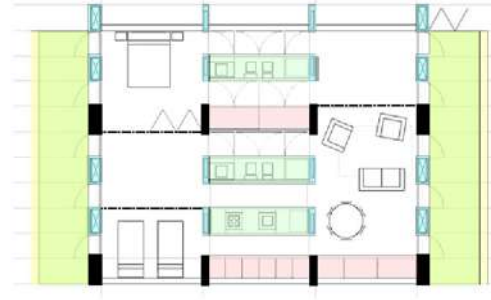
Planta Apartamento Tipo 3 - 98 m²
